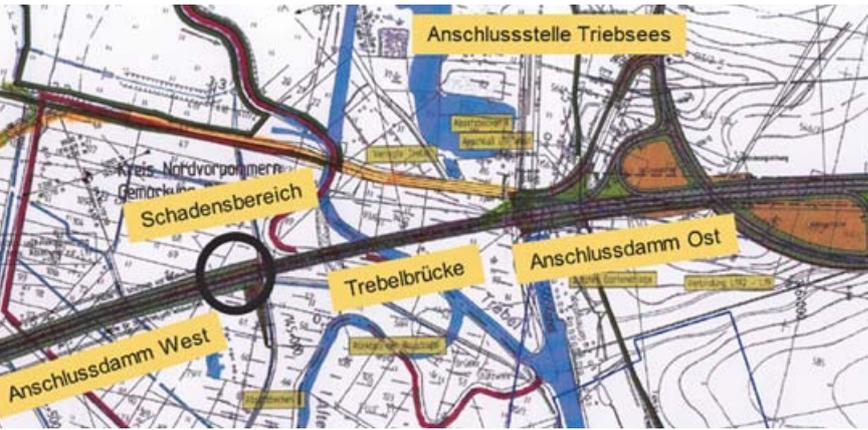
Übersicht Lage der Schadstelle: Brücke – Schadstelle – Damm
